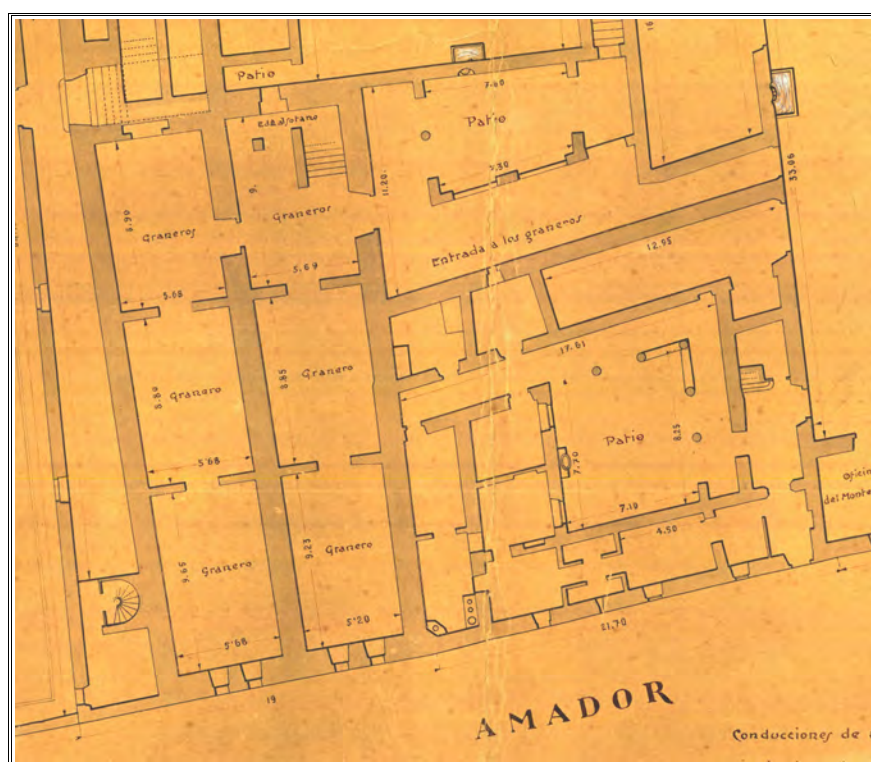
Detalle de la planta del espacio destinado para Colegio del Sr. Obispo, en el plano de Félix Caballero de 1920.
